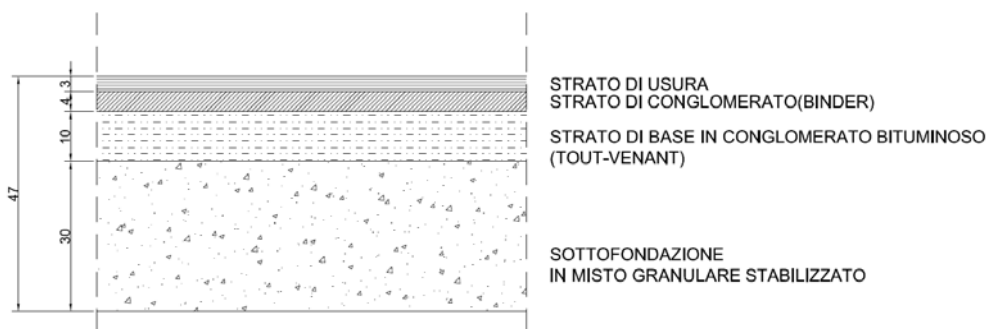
sezione tipo particolare pavimentazione tratte di nuova ealizzazione e allargamenti sedimi stradali esistenti
